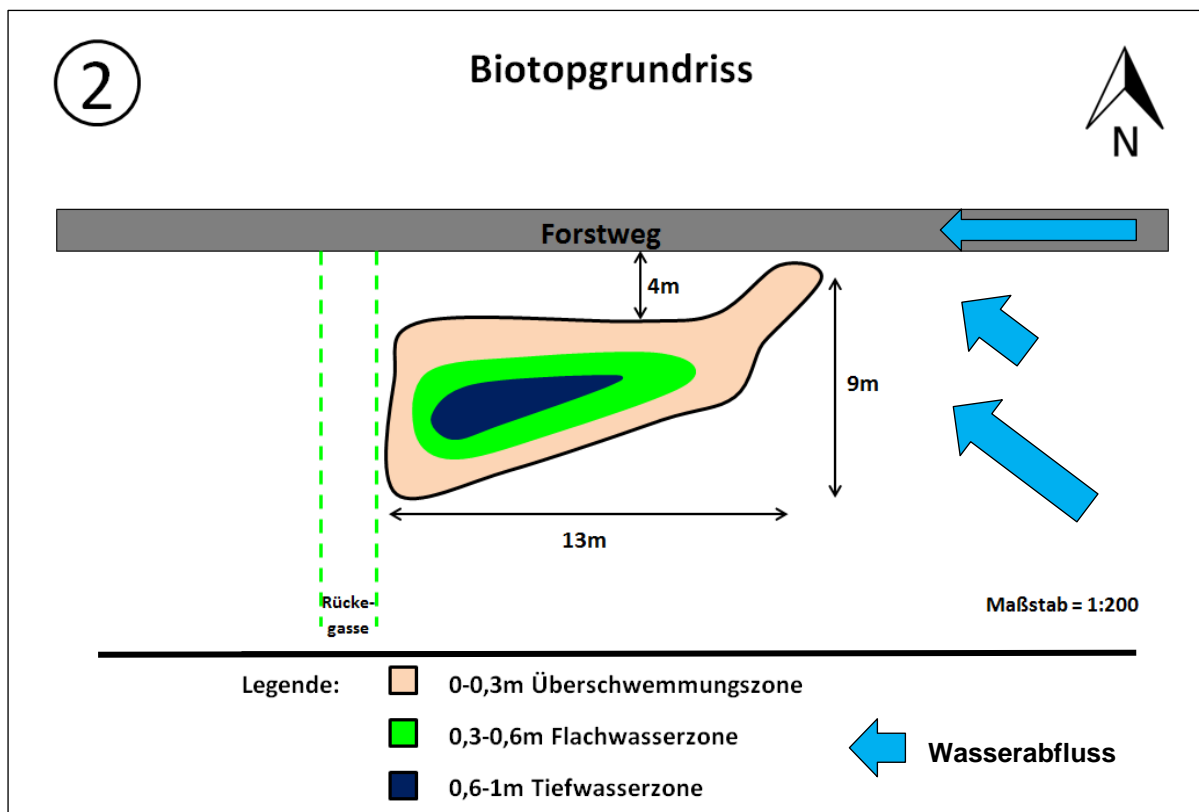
Grundriss von Biotop Nr. 2
